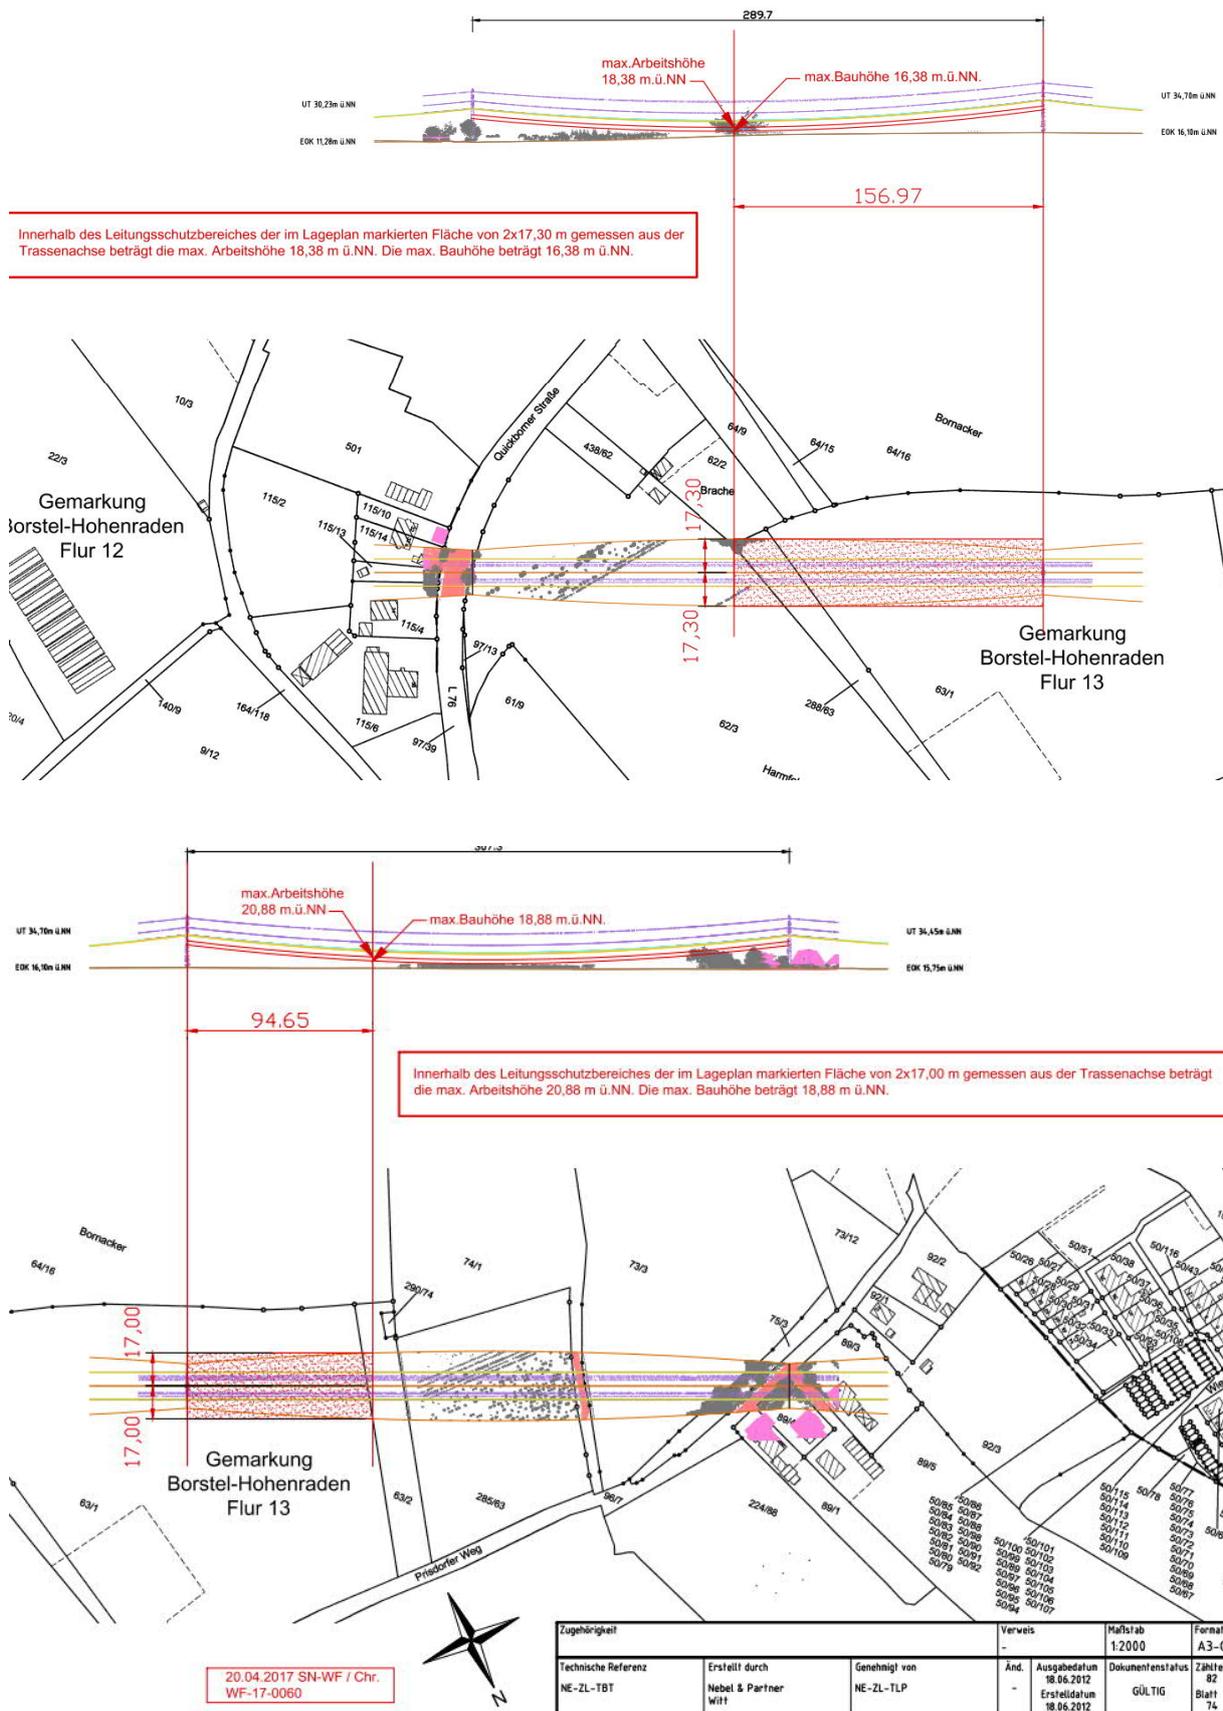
Lageplan der Leitungstrasse - Schutzbereich (ohne Maßstab)
